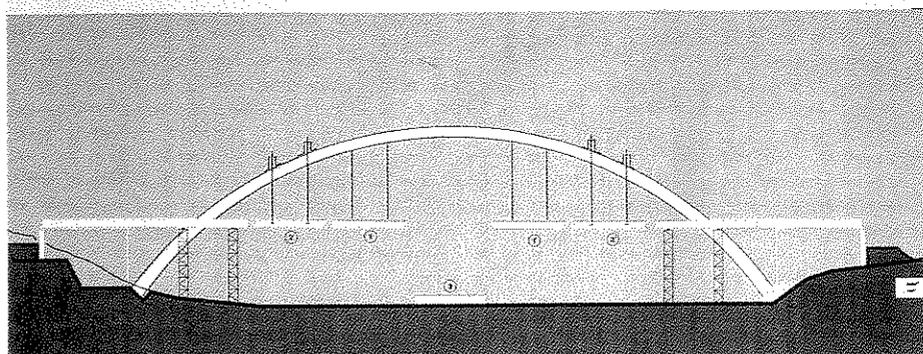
Ejecución fase 5. Izado de tramos centrales de tablero.
